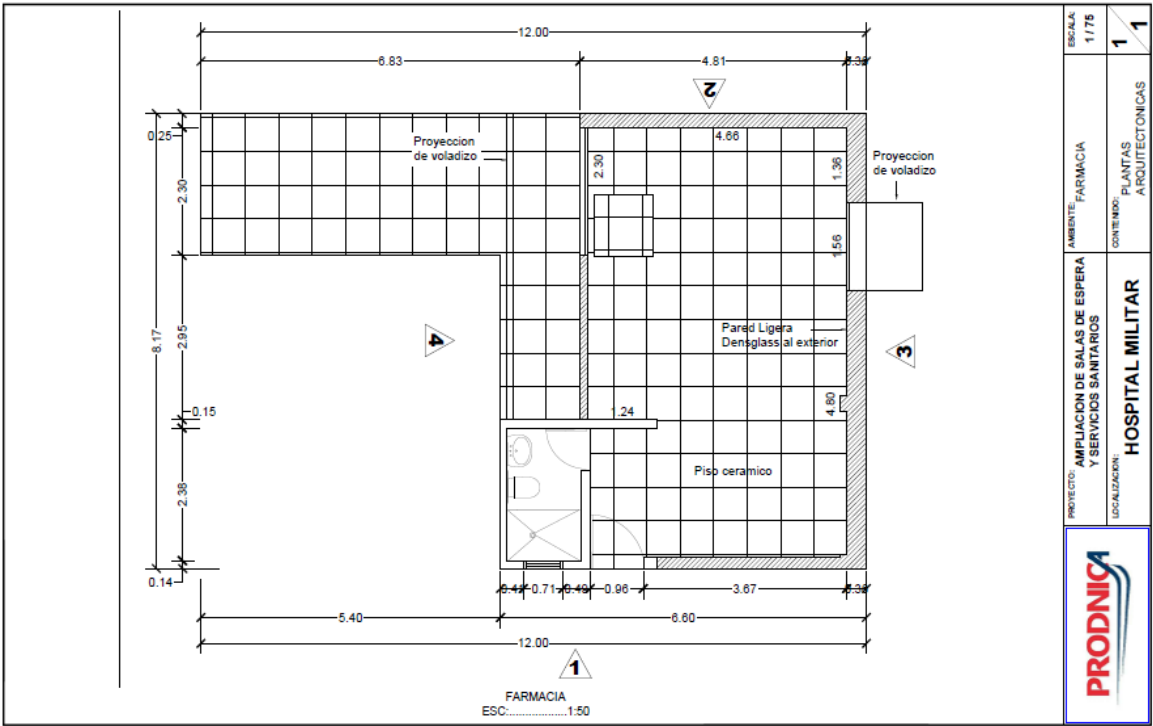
Lamina de planta arquitectónica de farmácia
